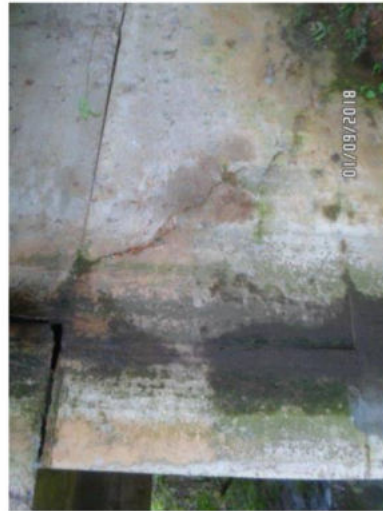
Fissura na mesoestrutura devido a falhas na aparelho de apoio.
